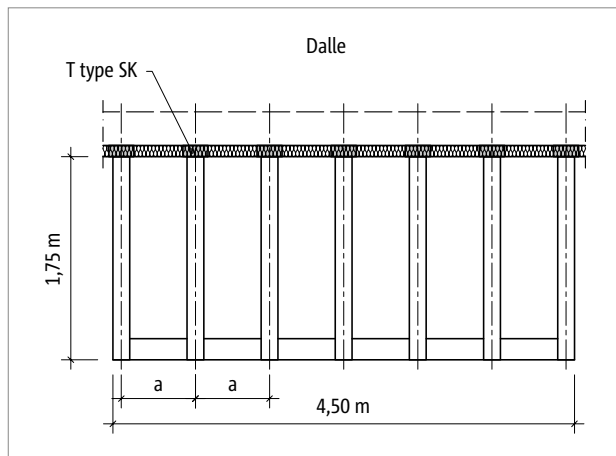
Schöck Isokorb® T type SK : Plan de base
